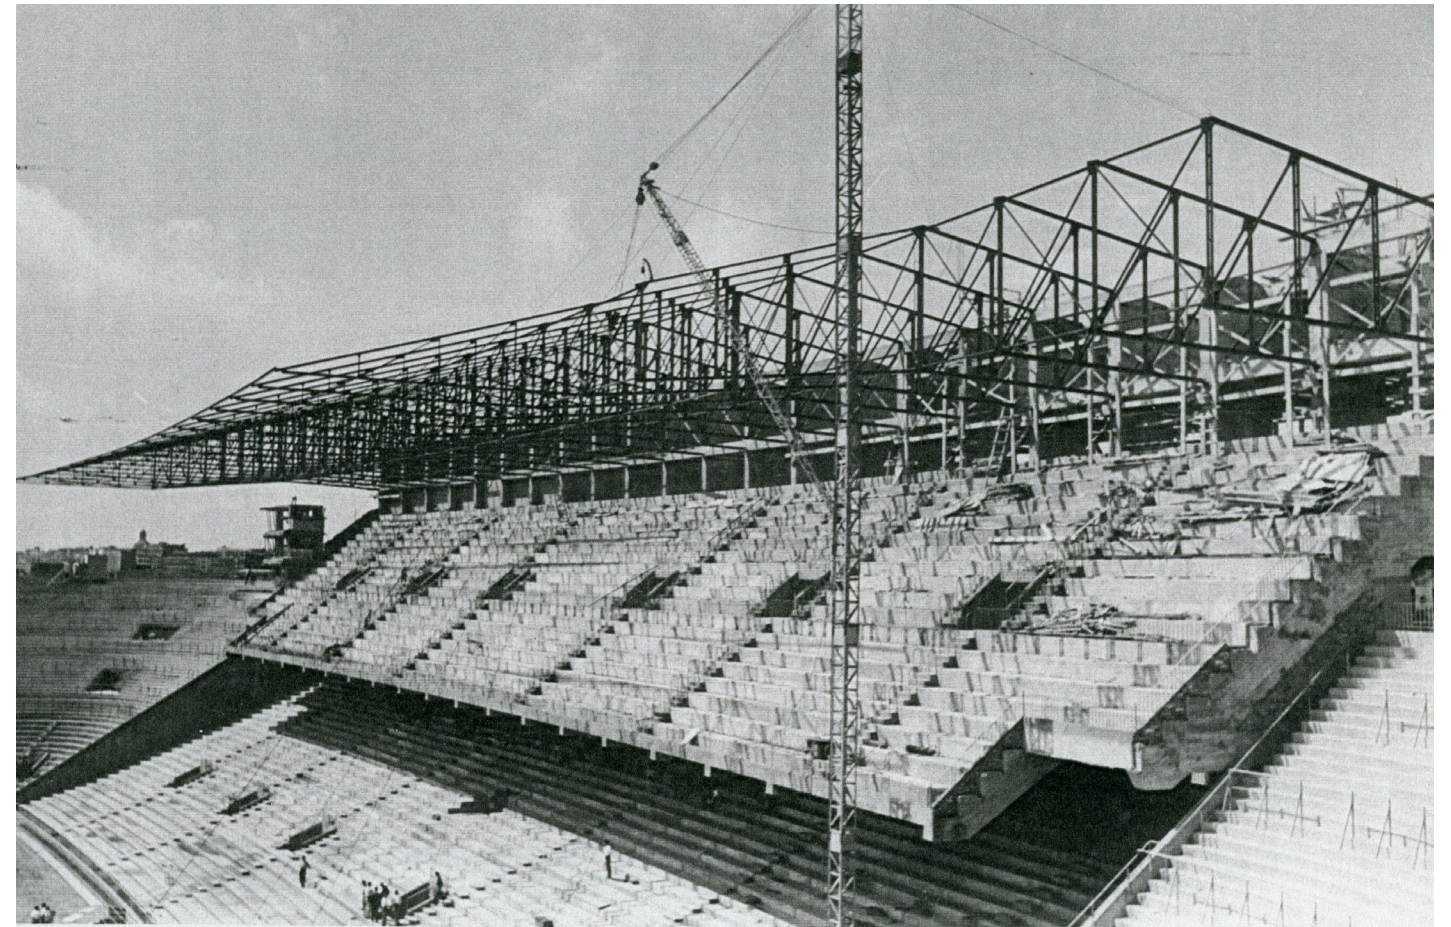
Fotografía de la cubierta en construcción del Campo de Mestalla.
